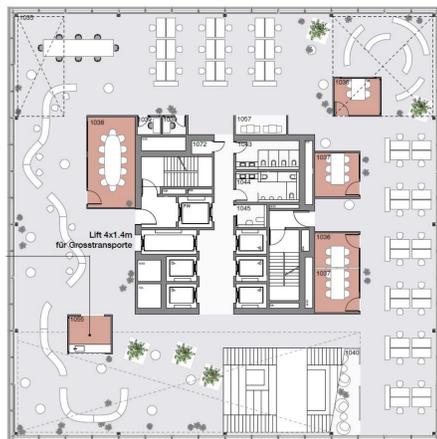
Grundriss 17. Obergeschoss
